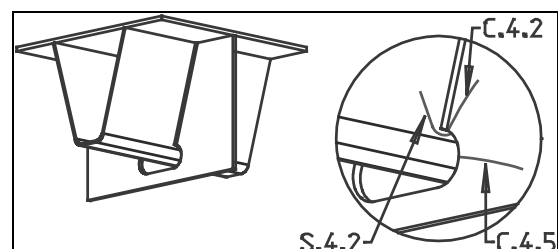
Durchgehende Trapezsteife mit ovaler Aussparung
